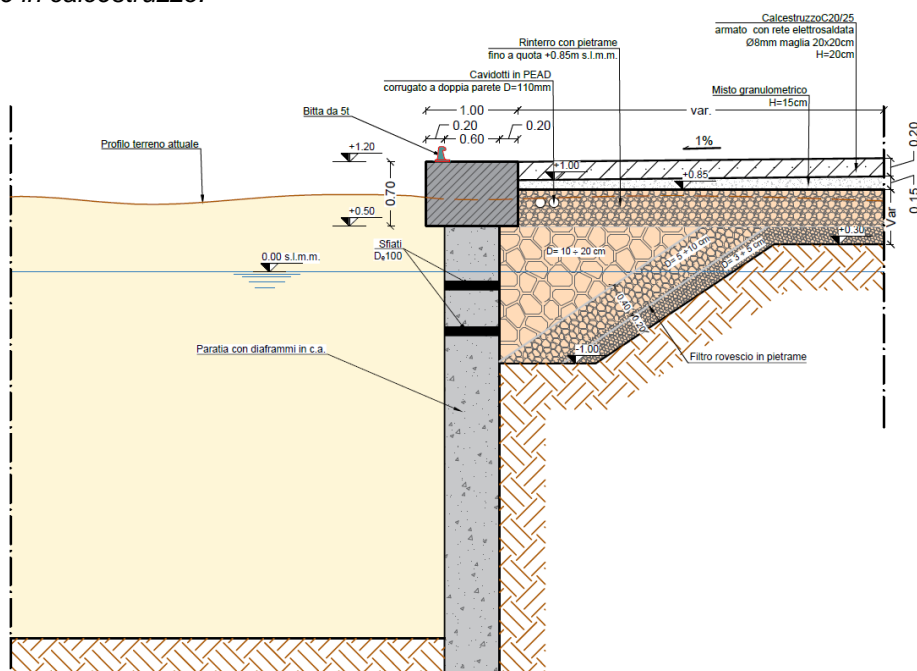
Sezione tipo banchina con paratia realizzata in diaframmi, nella fase antecedente il dragaggio
